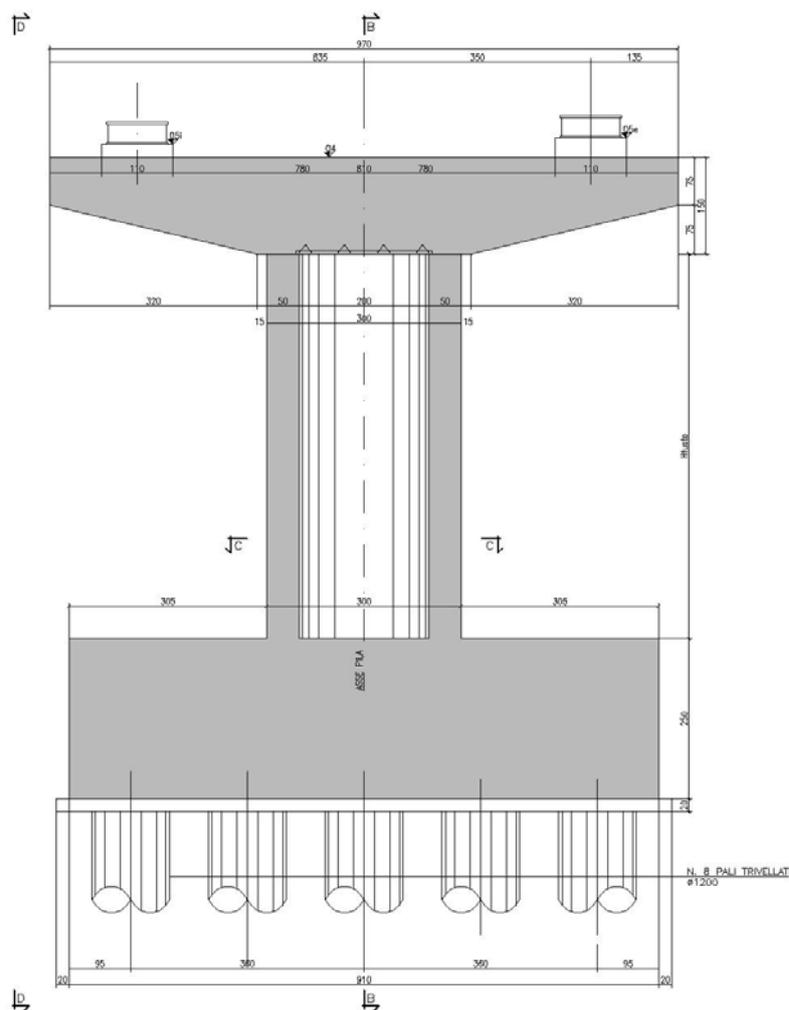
Sezione Trasversale pile progetto esecutivo.
